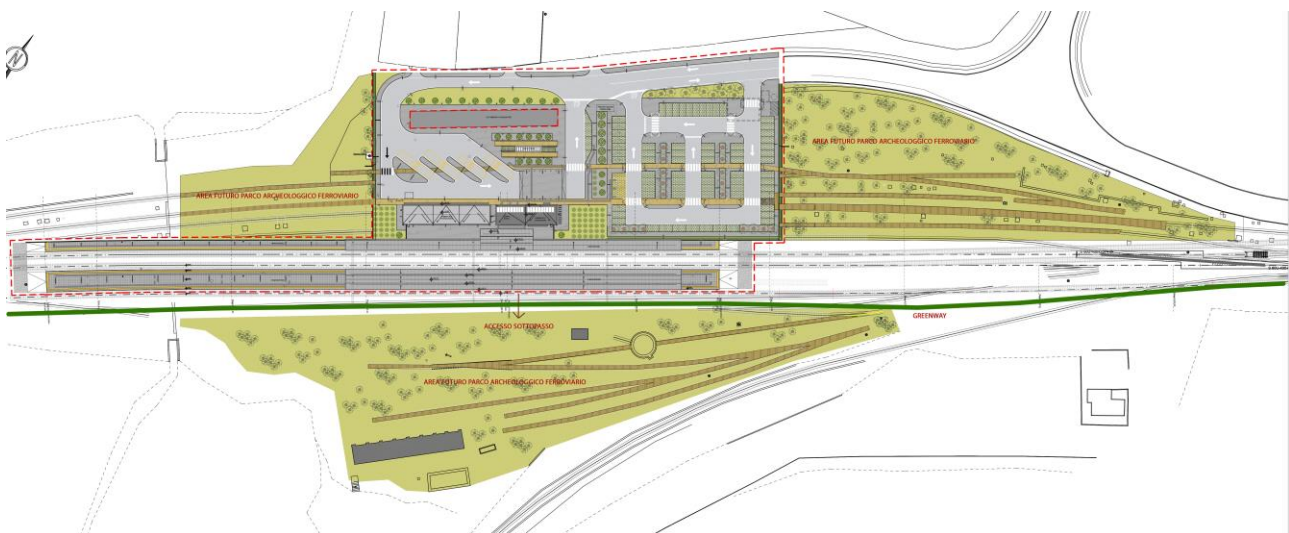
Planimetria generale con espansione futuro parco archeologico
